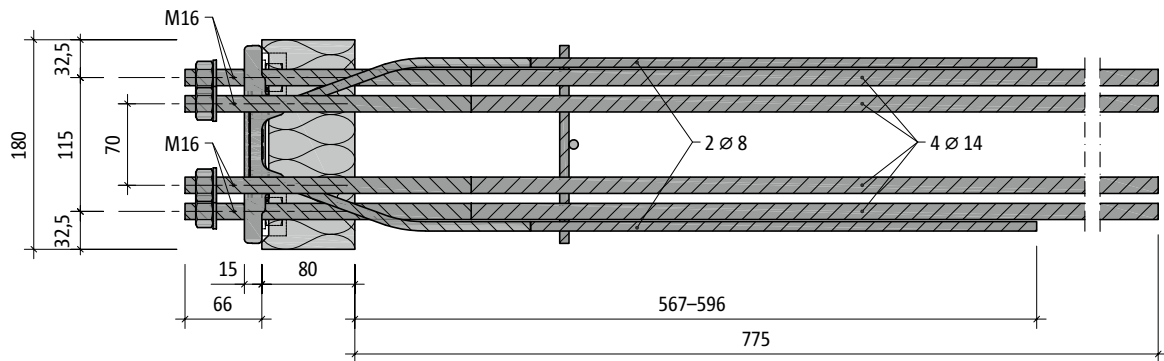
Schöck Isokorb® T type SK-MM1-VV1 : plan de base
